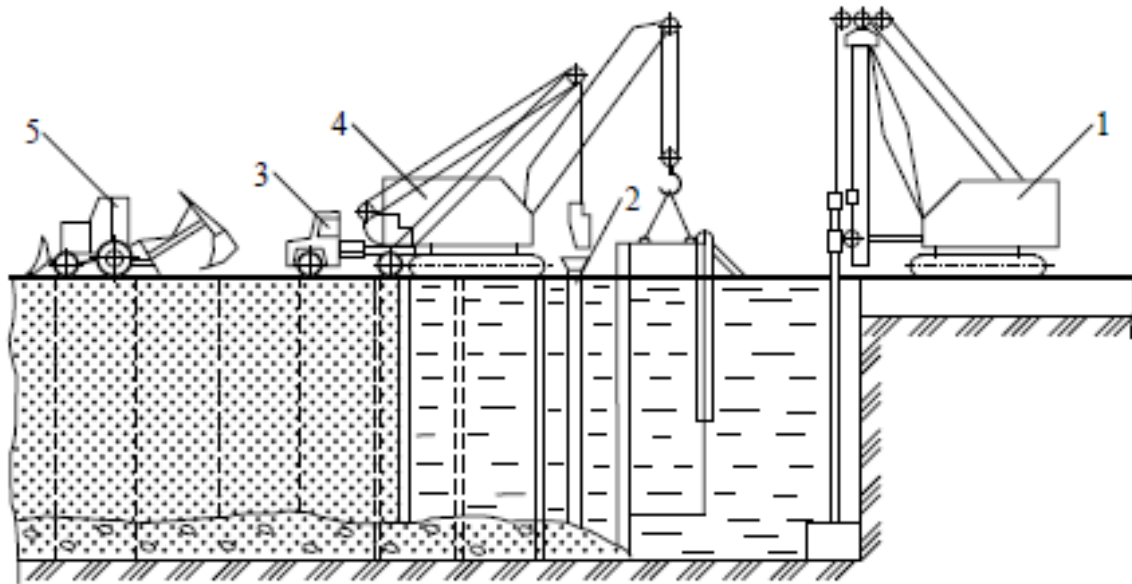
технологічна схема влаштування «стіна в ґрунті»: 1 – штанговий екскаватор; 2 – бетонолитна труба; 3 – автокран для укладання бетону; 4 – кран для монтажу панелей; 5 – механізм для зворотного засипання
